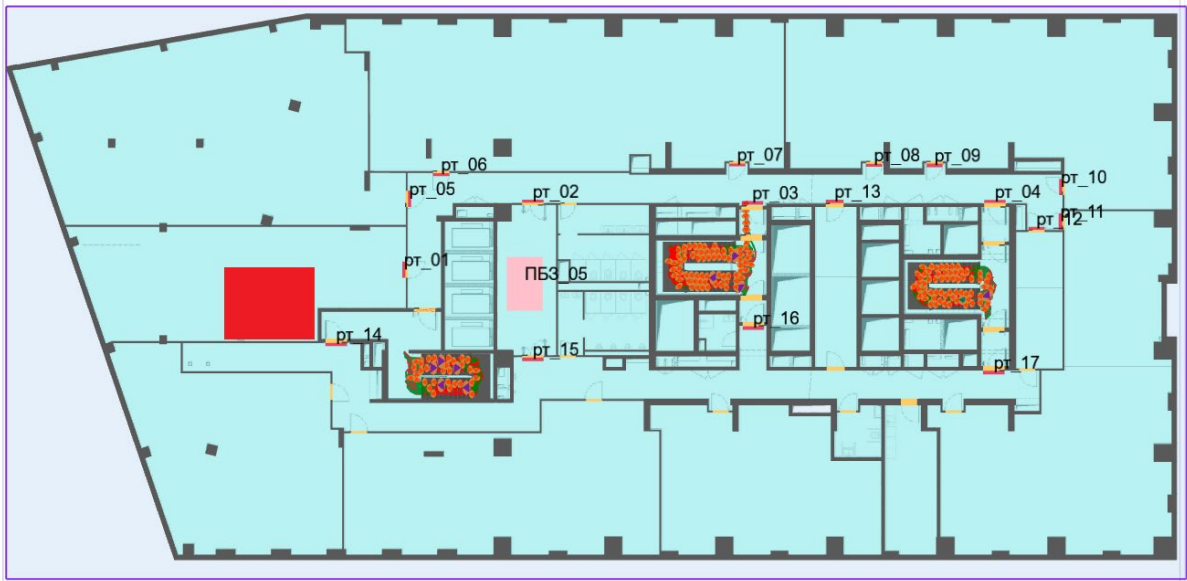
План 5-го этажа и нанесенная на него расчетная (принципиальная) схема эвакуации (расположение людей на момент полной эвакуации с этажа пожара – 2 мин. 22 сек.)
